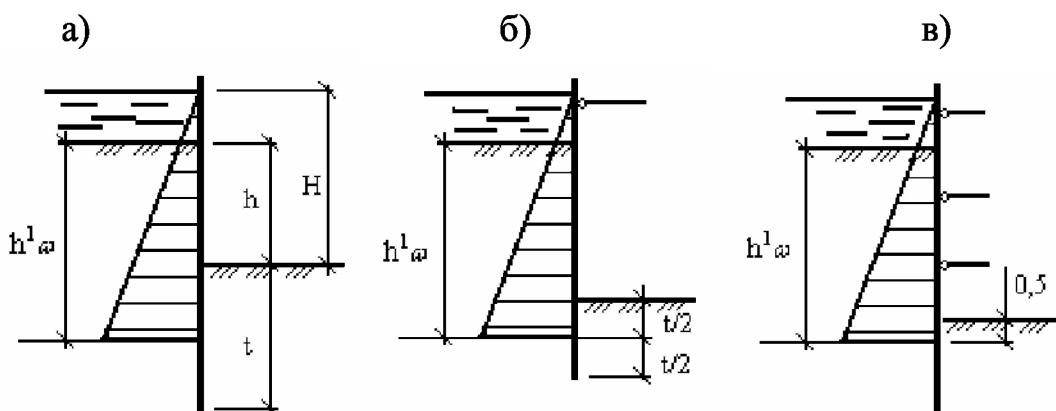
Эпюры гидростатического давления в пределах связного грунта: а – для свободно стоящих стенок; б – для стенок с одним ярусом креплений; в – для стенок с двумя и более ярусами креплений
